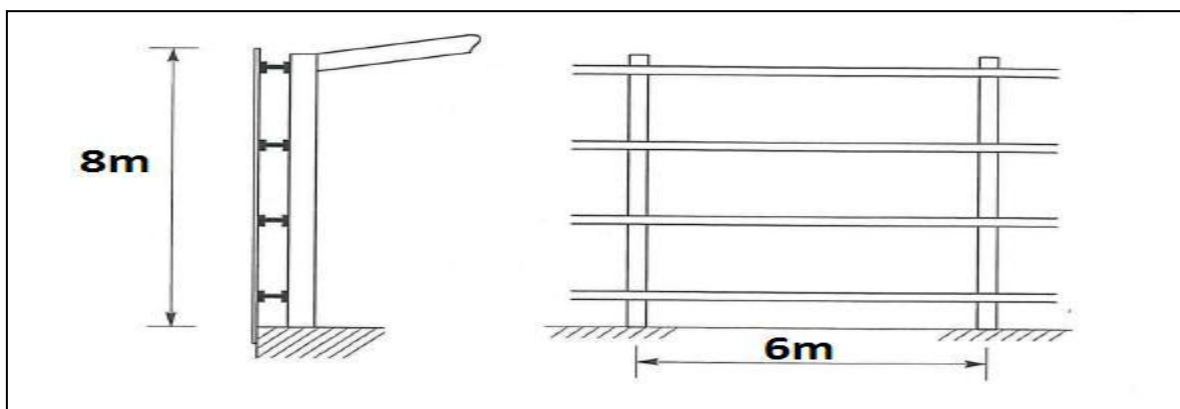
Disposition d'une lisse de bardage sur un potelet.
